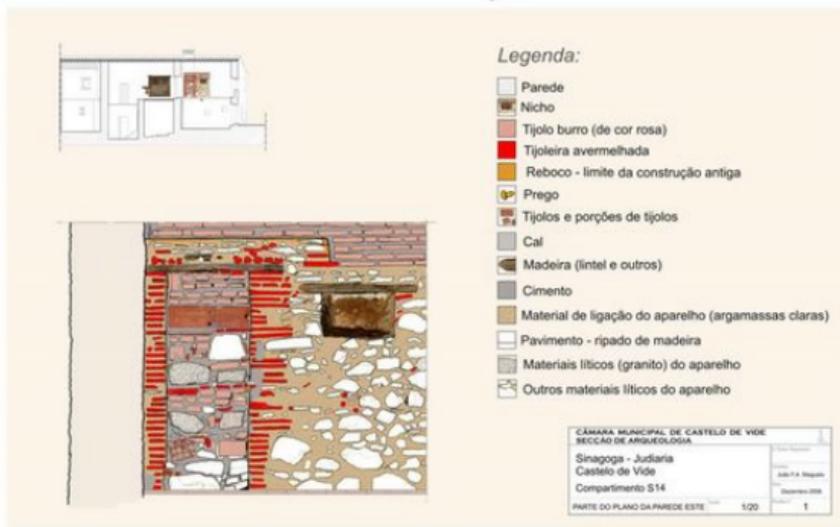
Pormenor do aparelho construtivo numa sala da cave
